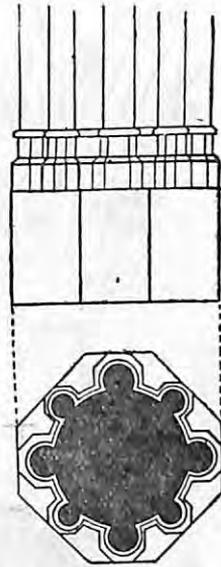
<sup>a</sup> — Planta y sección longitudinal de las basas y pilastras.
